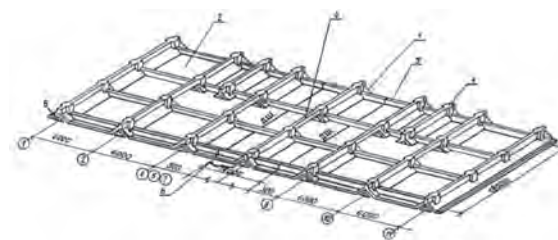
Общий вид монолитной конструкции фундамента-оболочки: 1 - складка фундамента; 2 - горизонтальная плита; 3 - вертикальные ребра жесткости; 4 - уширение под подколонник; 5 - горизонтальная балка; 6 - вкладыш под внутреннюю полость складки фундамента; ДШ - деформационный шов.
